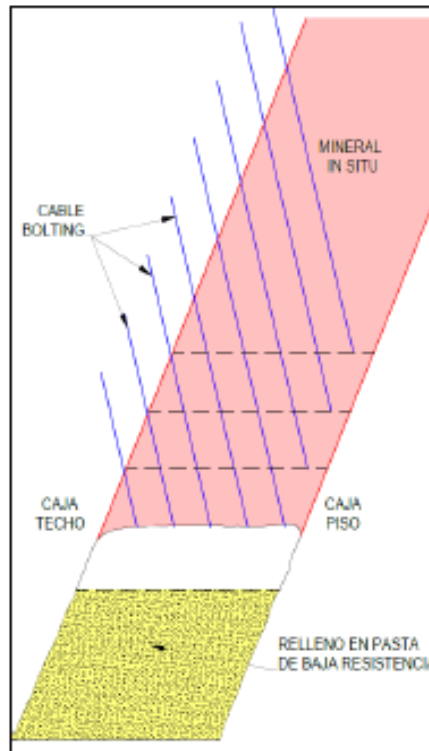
Esquema del minado en realce con la instalación de cable bolting (pre-refuerzo) en el techo y caja techo para buzamientos menores a 60°.
